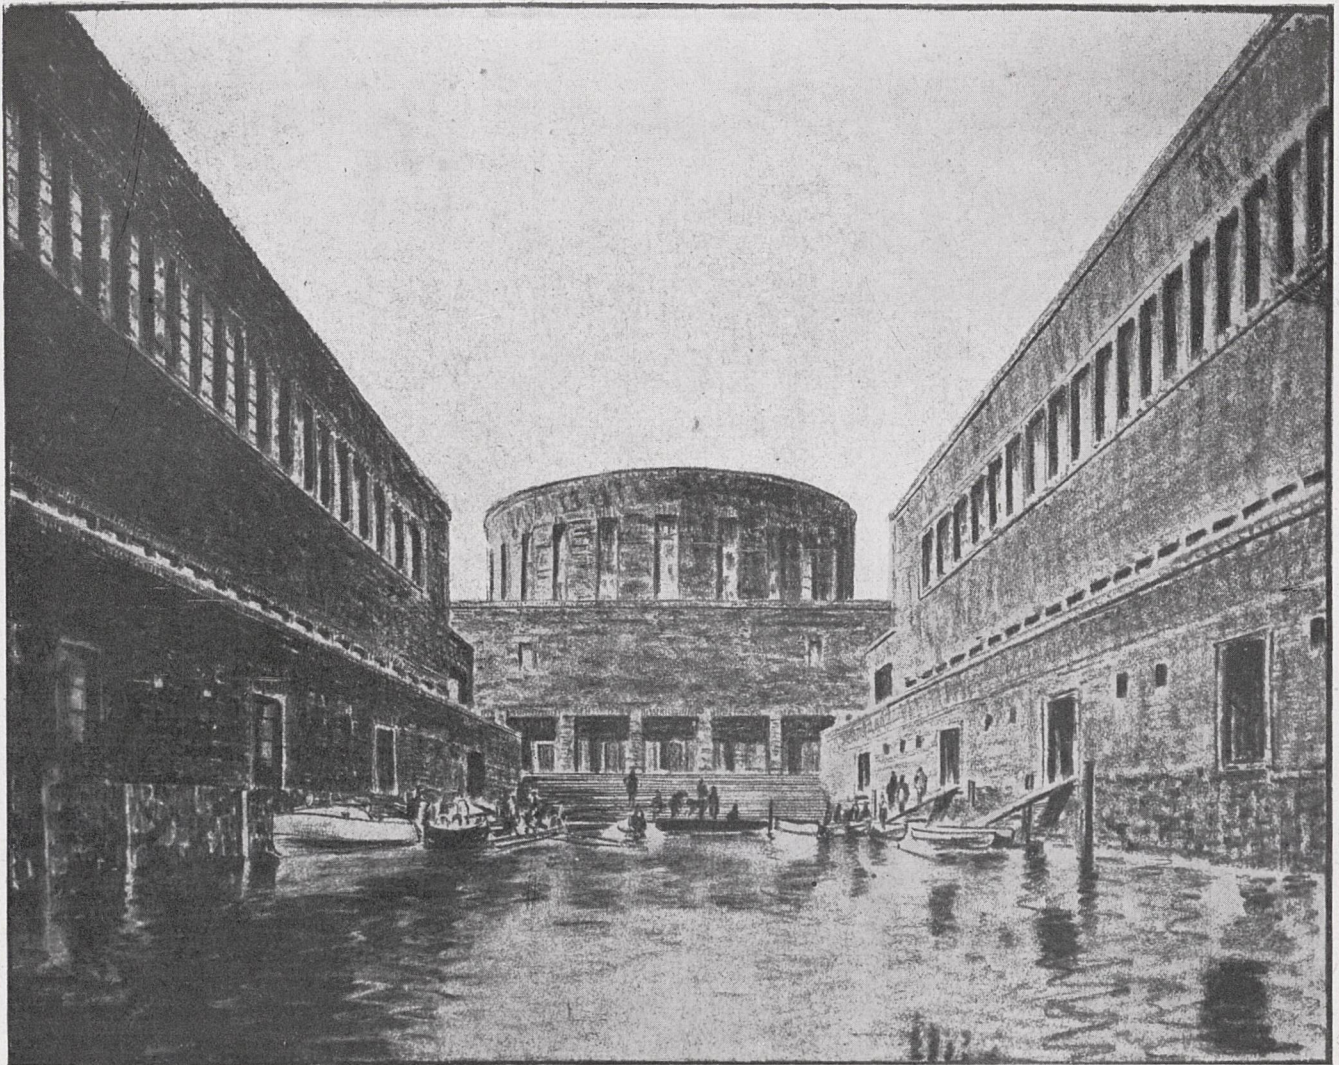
Wasserbecken mit Aulagebäude und Turnhallen.
